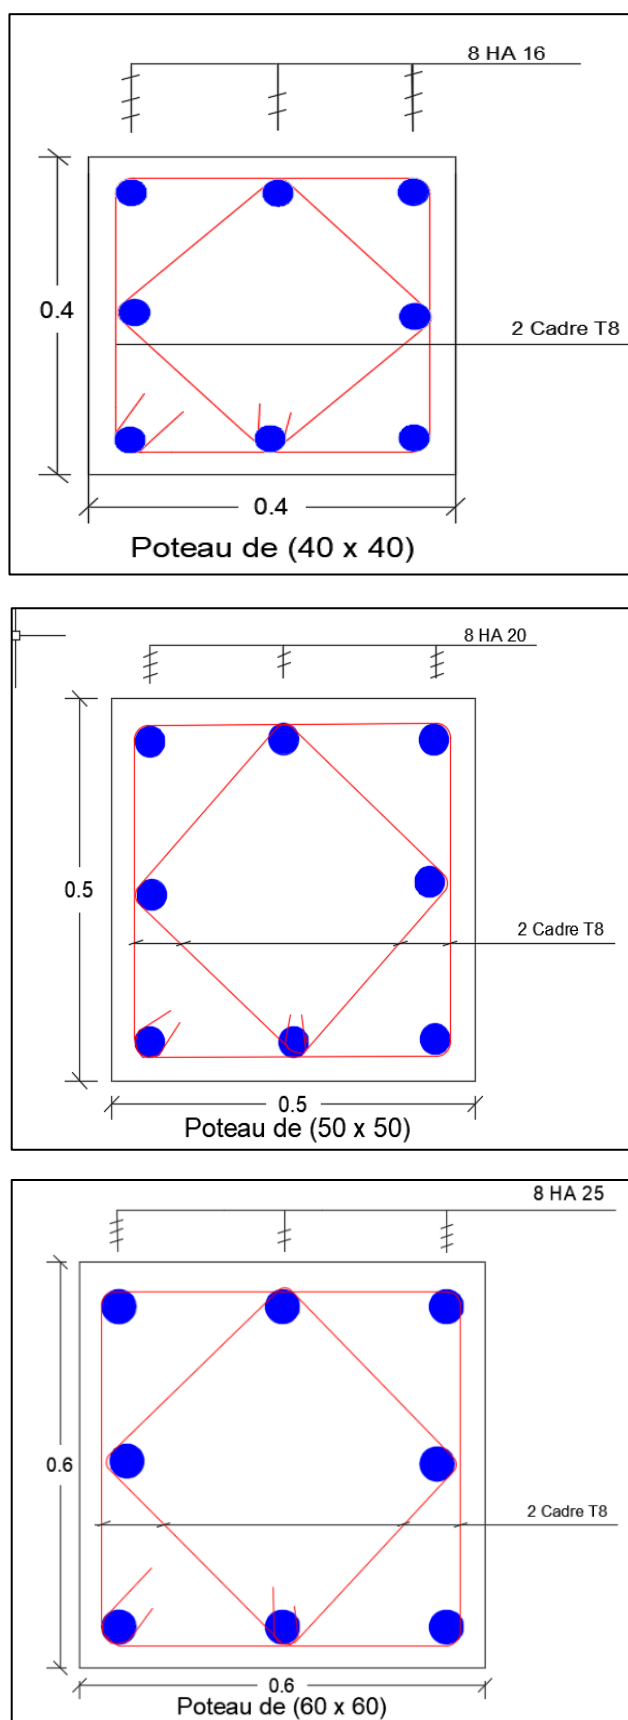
Plan de ferrailage en coupe transversale des poteaux
